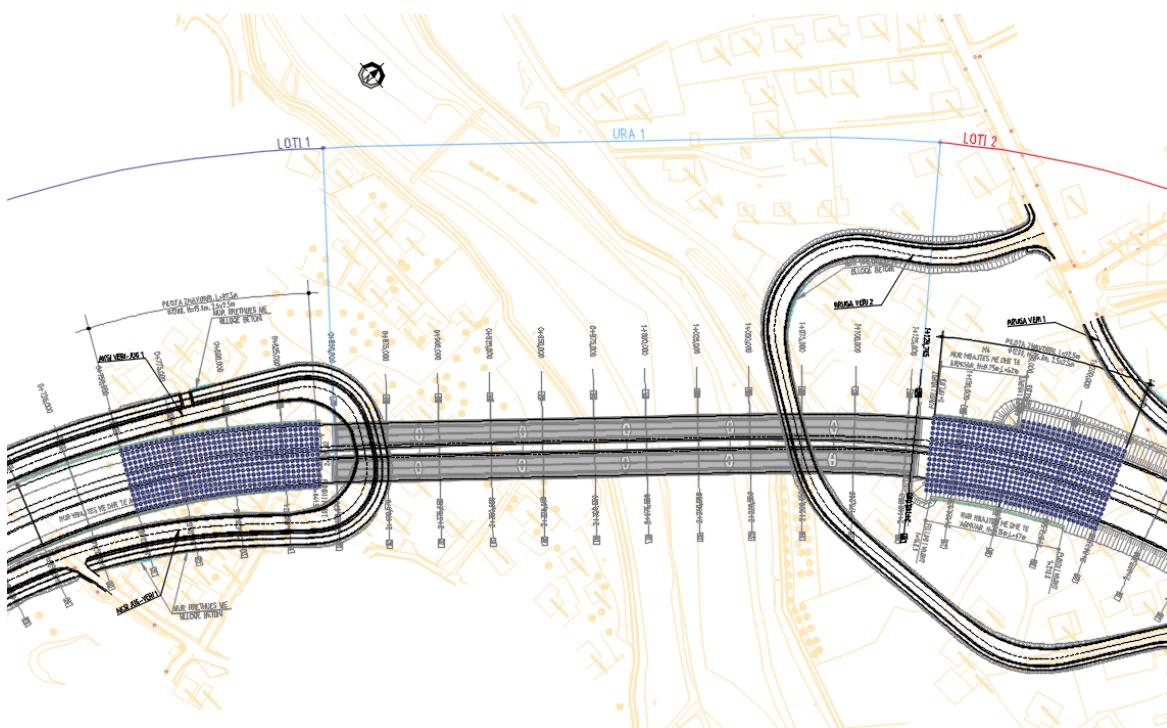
Fragment nga planimetria ku tregohet menyra e vendosjes se pilotave
